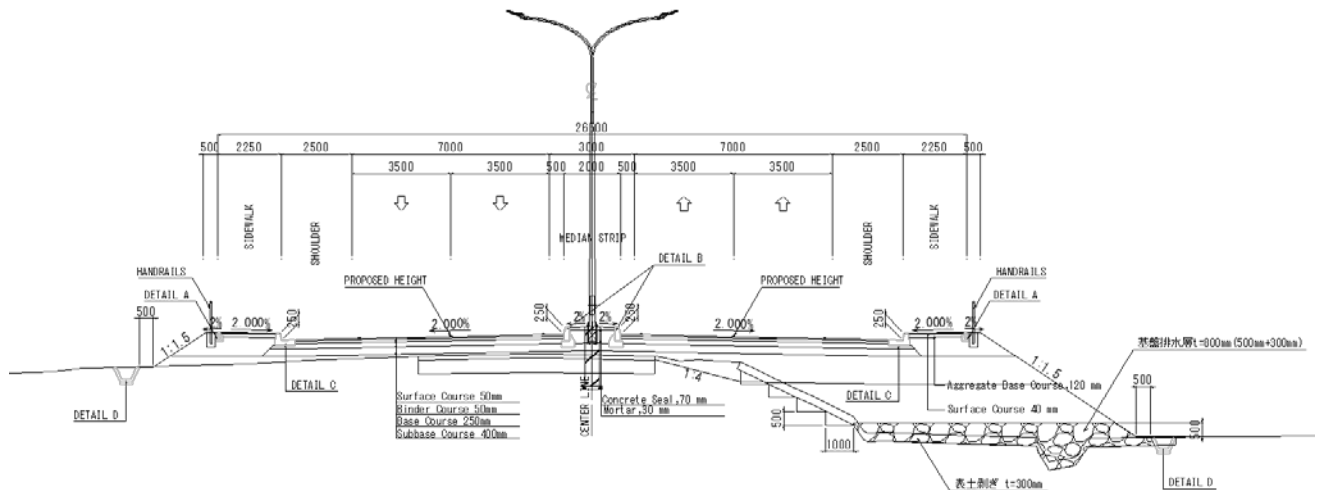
標準横断面図 (一般区間 : 起点から STA.807+20 まで)
